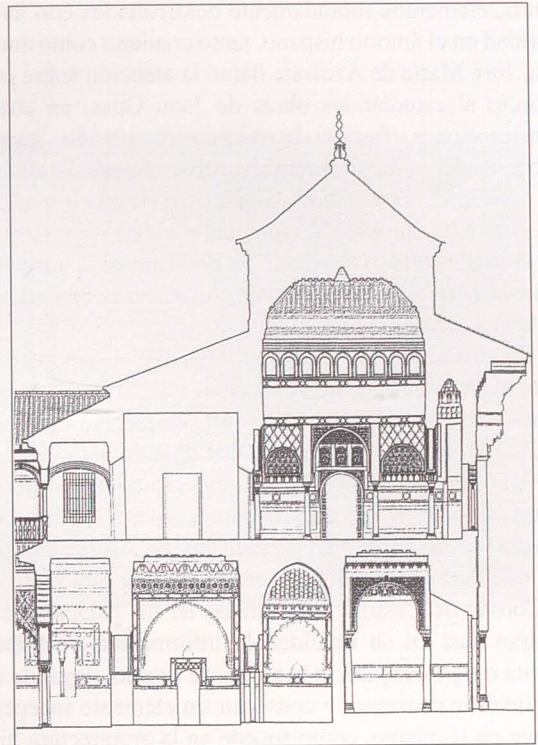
Sección de la fachada de la Monería, 1364. (A. Almagro Gorbea).
